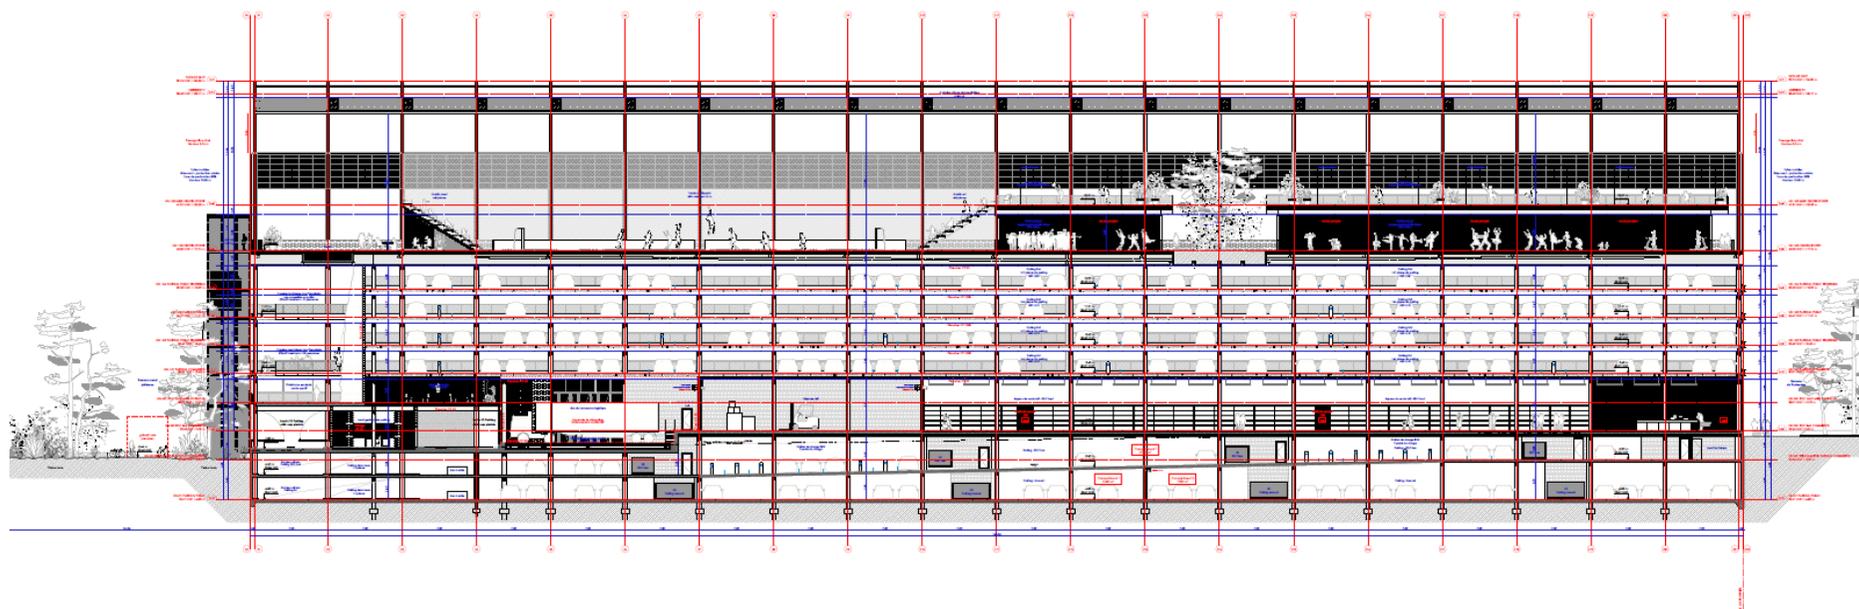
Coupe transversale Est-Ouest du bâtiment projeté
